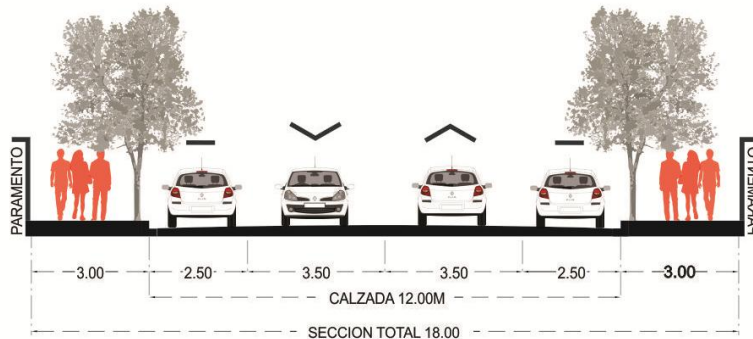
Sección Vialidad Acceso a Colonia.
